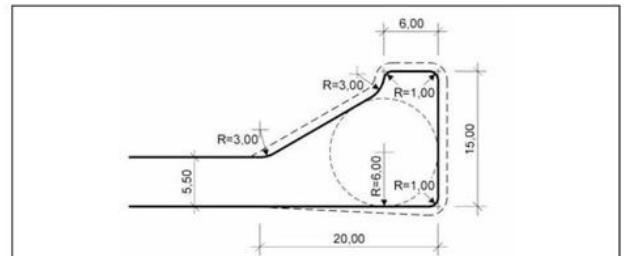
Flächenbedarf für einen einseitigen und zweiseitigen Wendehammer für Fahrzeuge bis 10,00 m Länge (3-achsiges Müllfahrzeug)
